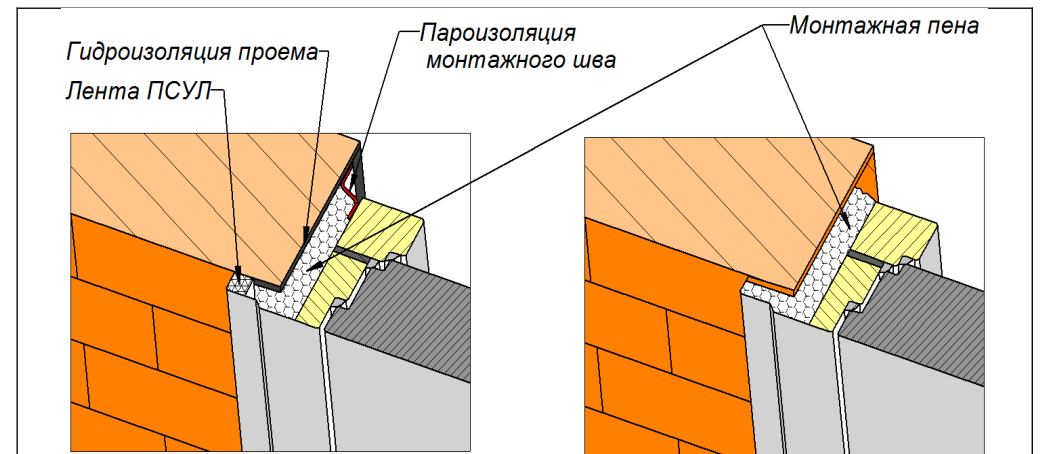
Схема ПРАВИЛЬНОГО монтажа дверного блока в проем кирпичного дома (Выполнена гидроизоляция проема, наклеена лента ПСУЛ по периметру наличника, выполнена пароизоляция монтажного шва)
